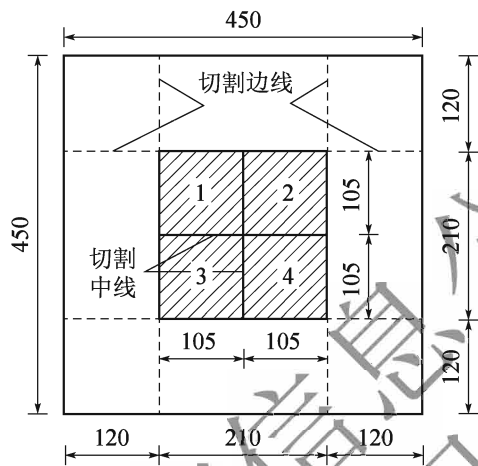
切割线位置示意图 (尺寸单位: mm)
